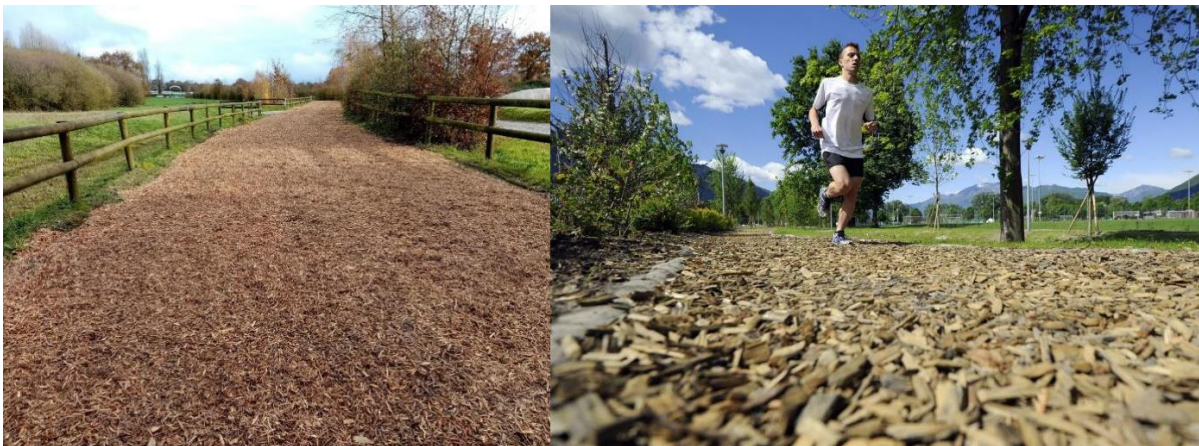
Revêtement en plaquettes bois dans un centre équestre et piste finlandaise (Source : Sylvain Georget et <https://www.cstenero.ch/>)
